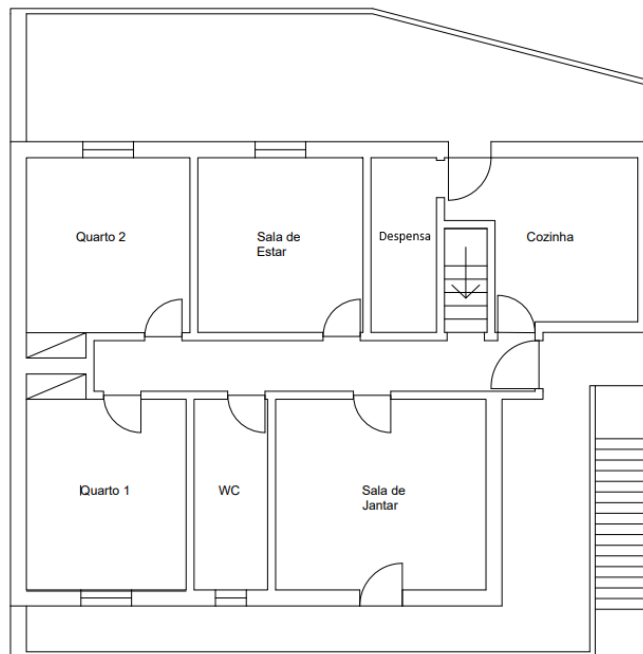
Planta existente do piso 1. Fonte: Tânia Tavares
